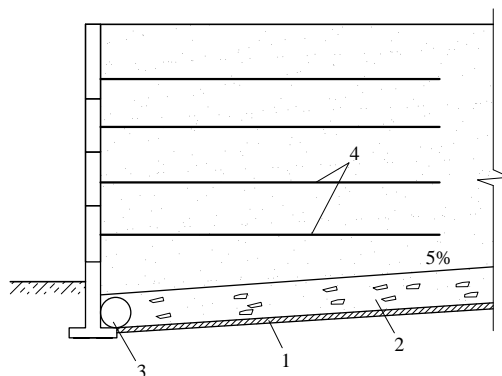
Схема дренажу підпірної стінки: 1 – ущільнена глина; 2 – дренажна засипка; 3 – дренажна труба; 4 – армувальні елементи
